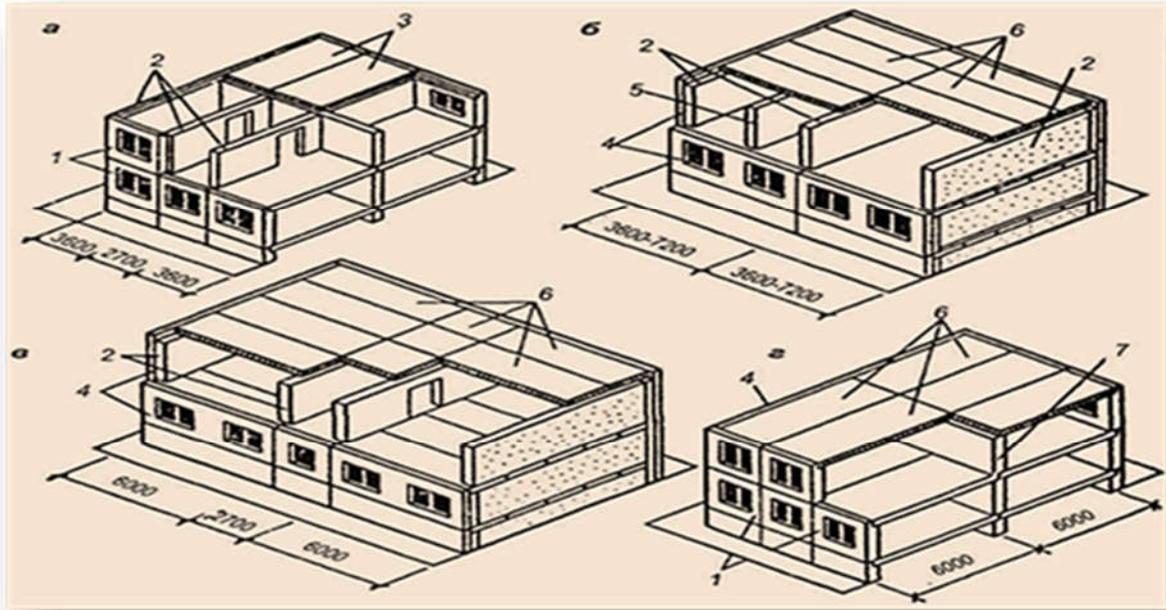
Конструктивні схеми безкаркасних великопанельних будівель
